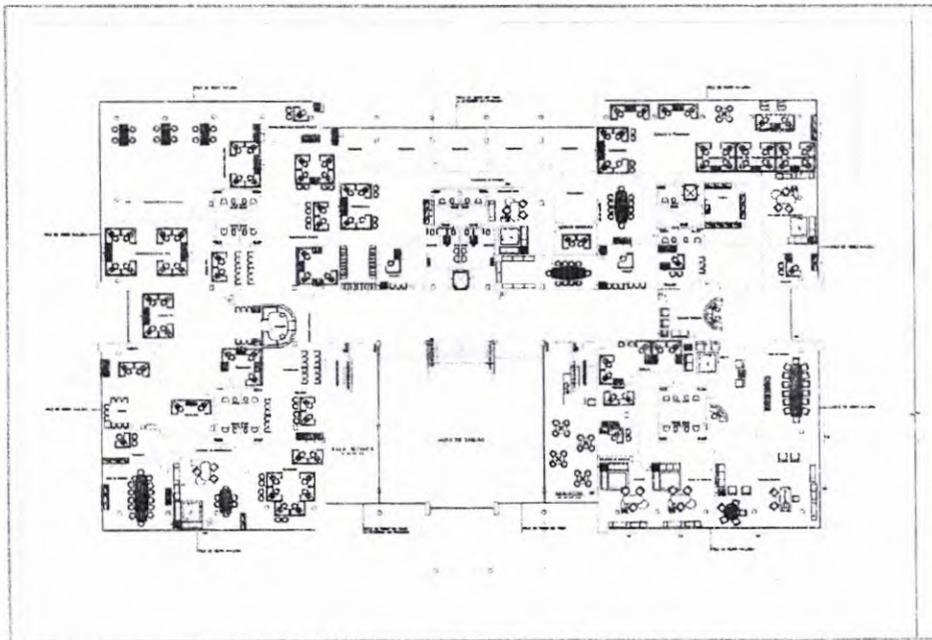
Segundo pavimento, afetado pelo incêndio.
